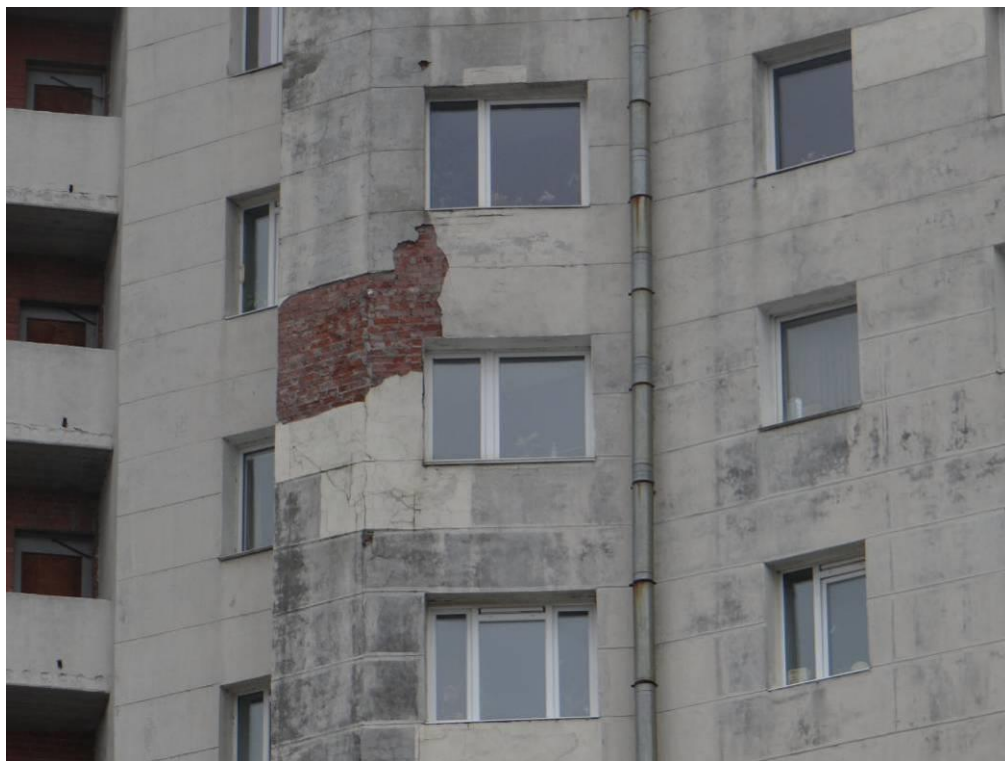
Фрагмент фасада по оси «Б» на участке в осях «5» - «7» в уровне 10 этажа. Следы увлажнения поверхностей фасада, приуроченные к подоконным отливам. Сети разнонаправленных трещин в штукатурном покрытии. Участки обрушения штукатурного покрытия. Морозное разрушение материалов кирпичной кладки.
